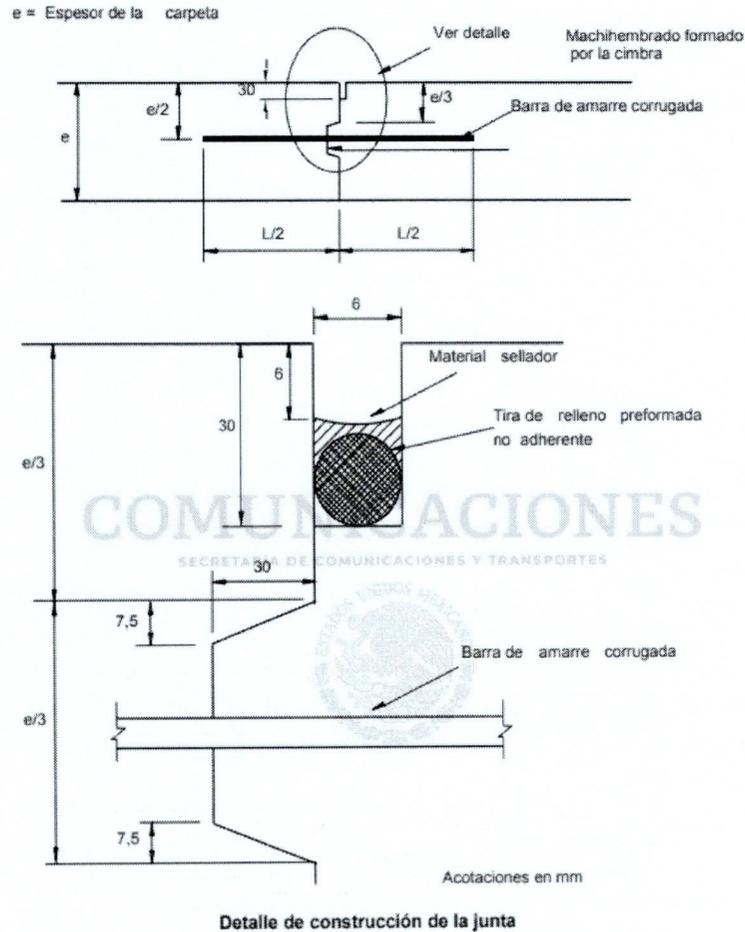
Corte y sellado de juntas longitudinales de construcción (Tipo B) con barras de amarre
